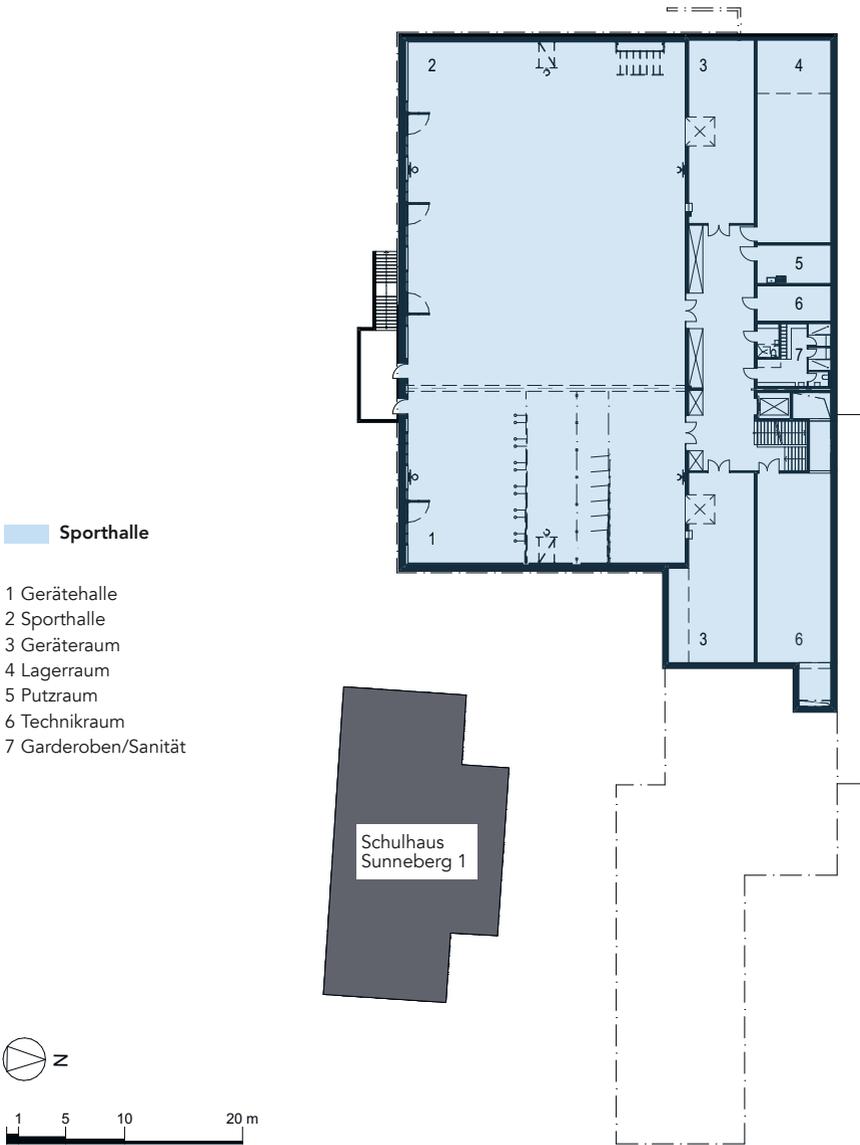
| Grundriss Untergeschoss (Hallengeschoss mit der Nutzung 1/3 (Gerätehalle) und 2/3)
